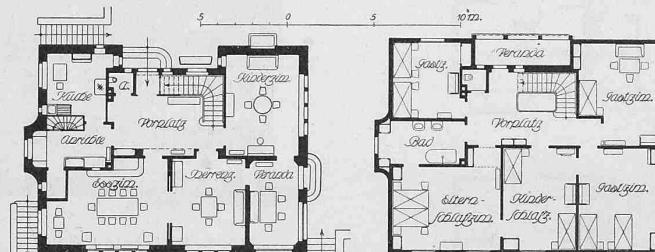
und 3. Grundrisse des Hauses Wirth in Dietfurt. — 1:400.
